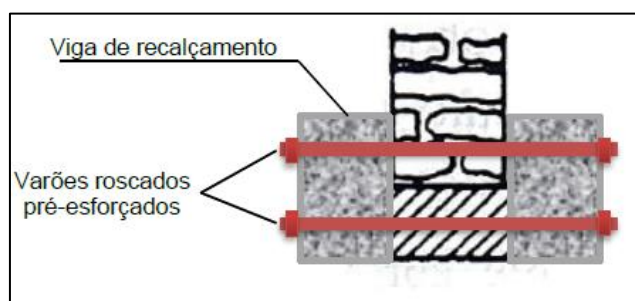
Alargamento de uma sapata contínua com vigas de betão e varões de pré-esforço (Fonte: NEVES, 2010).
